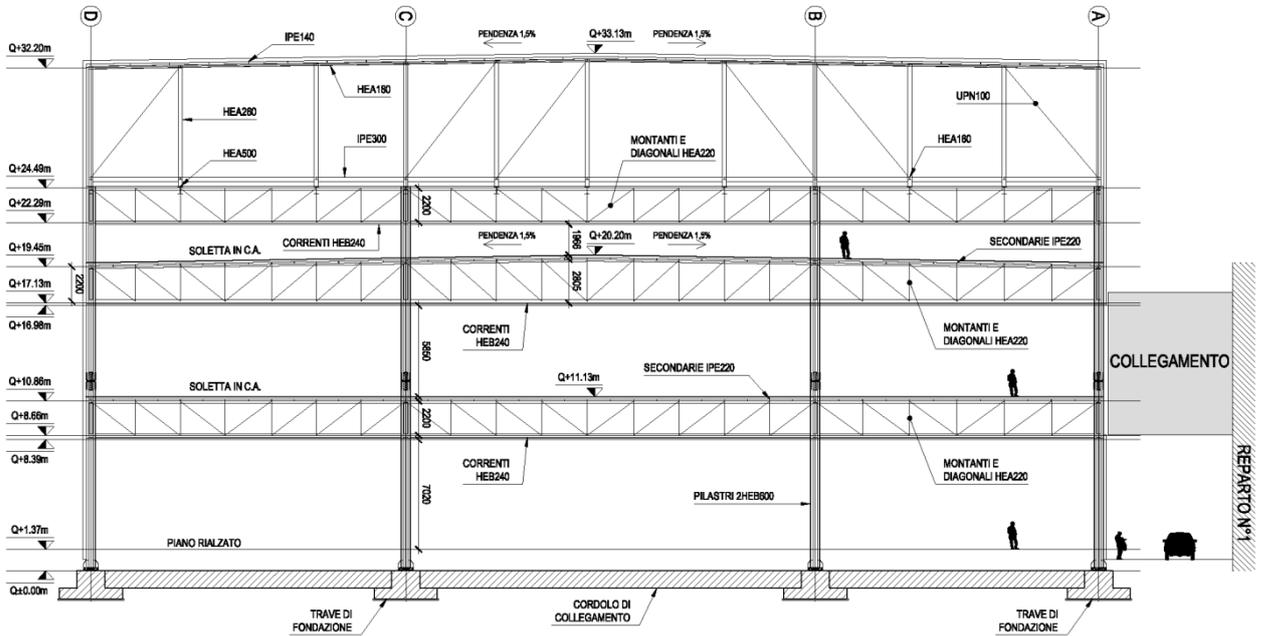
Sezione longitudinale tipo struttura di elevazione
